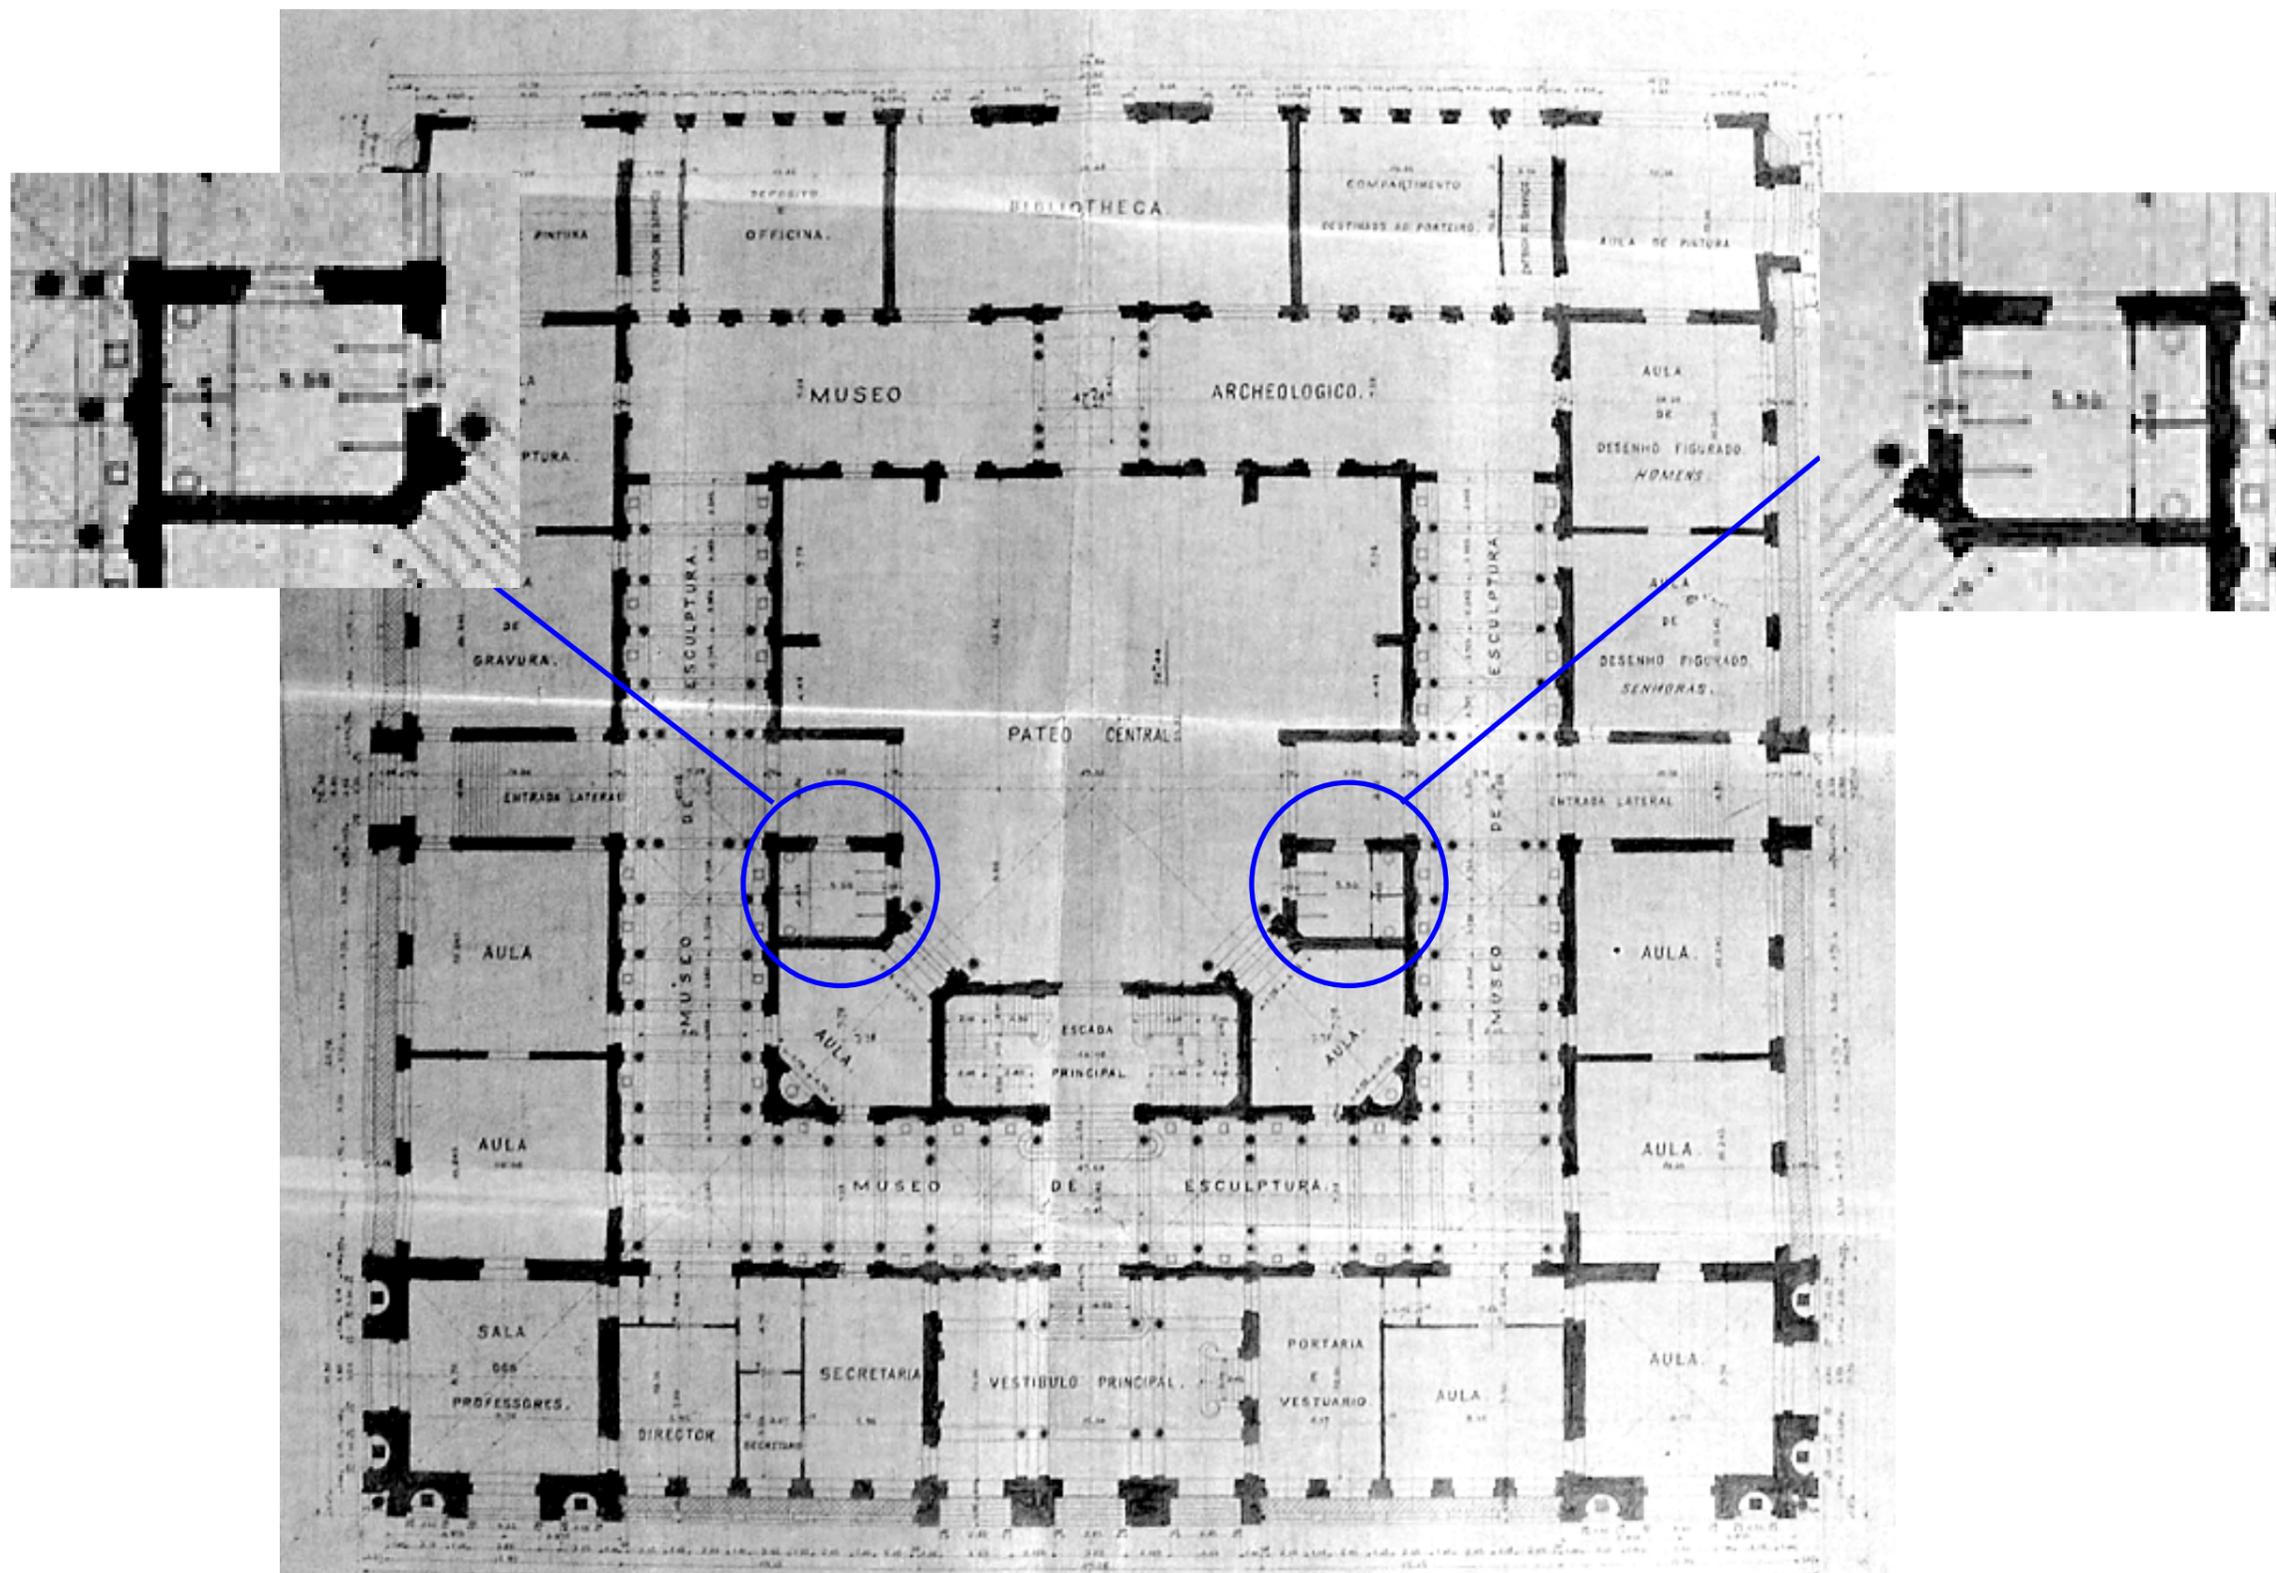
Planta do 2º pavimento da Escola Nacional de Belas Artes, projeto de Morales de los Rios, indicando os dois sanitários projetados no pavimento, junto ao pátio central (Arquivo Nacional).
